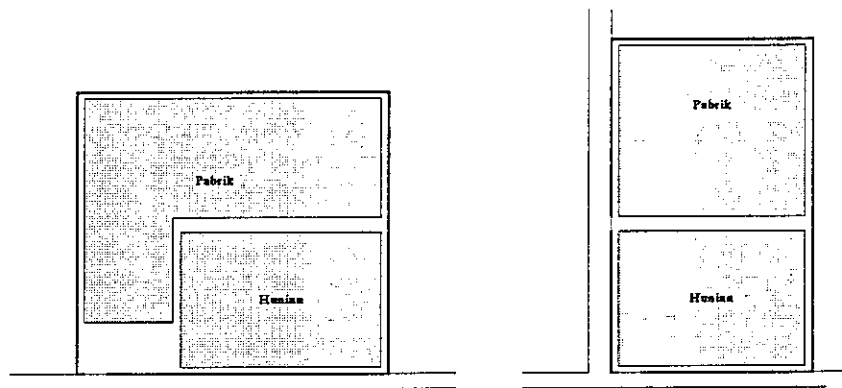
Bangunan hunian bergabung pabrik batik bermasa tunggal
